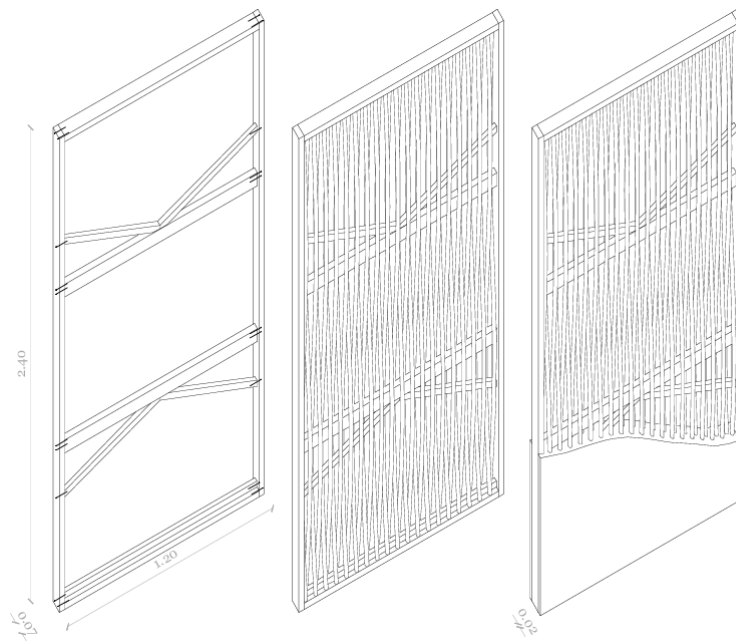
Sistema de unión entre quincha prefabricada y estructura.
